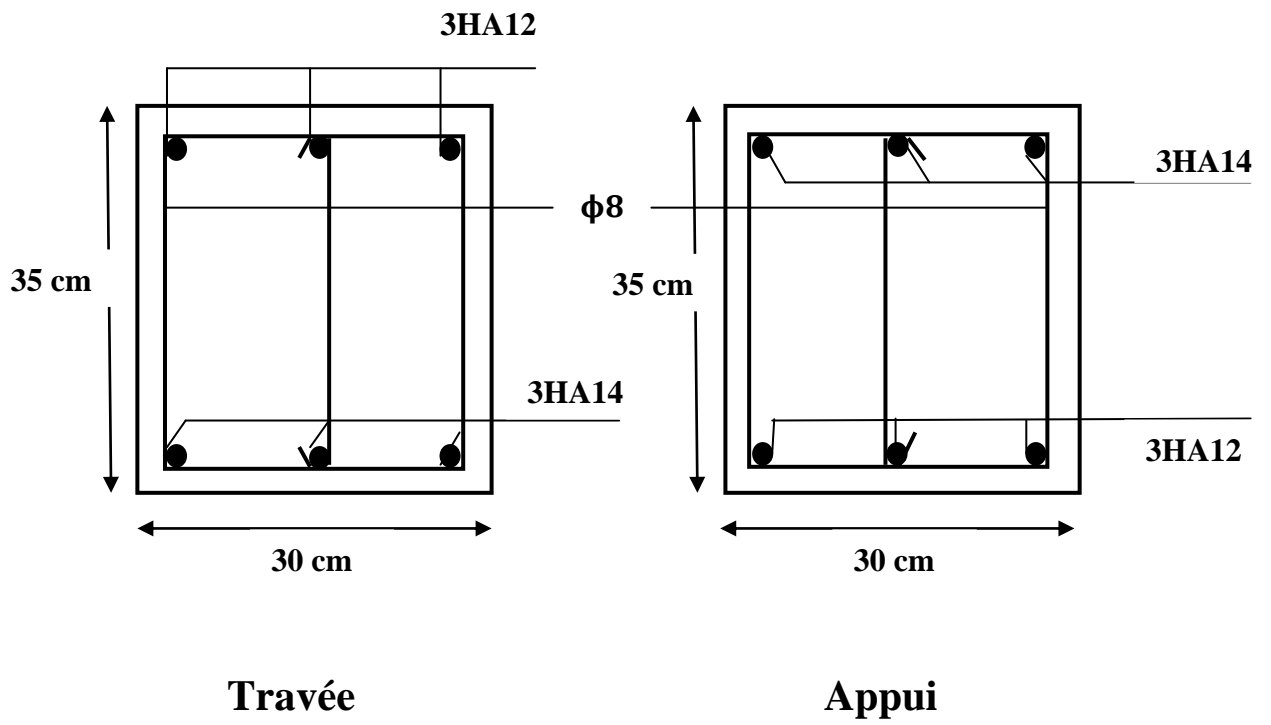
coupe de ferraillage du Poutre Secondaires.
